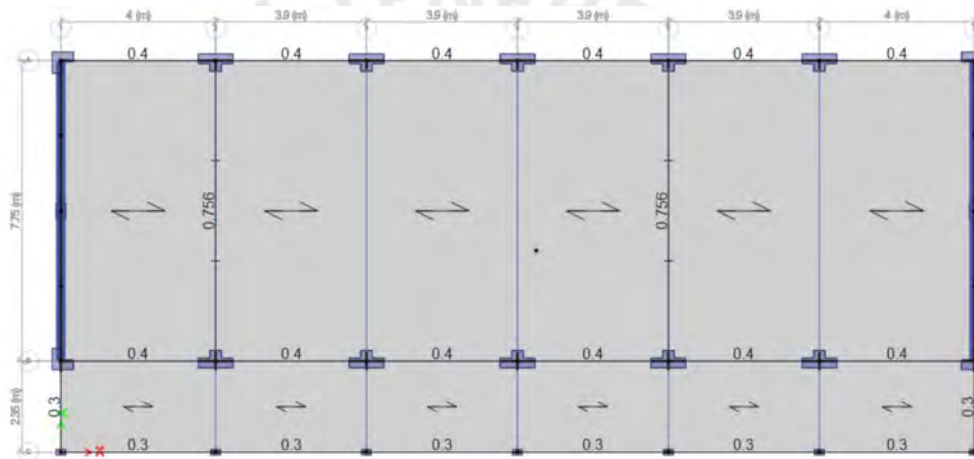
Carga distribuida en las vigas debido a la tabiquería (Techo 1/ETABS)
